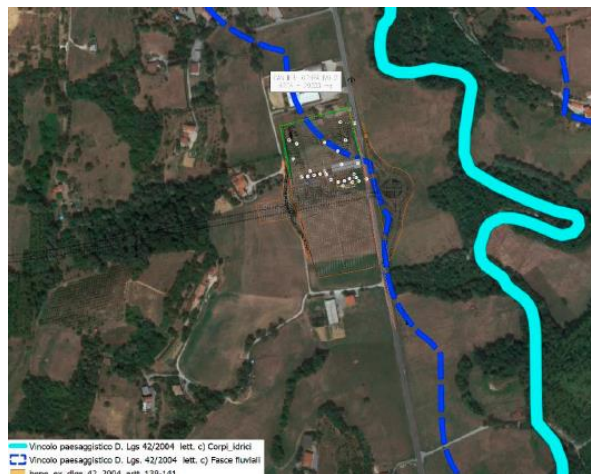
Asse principale – Layout cantiere operativo 2 - Vincoli
